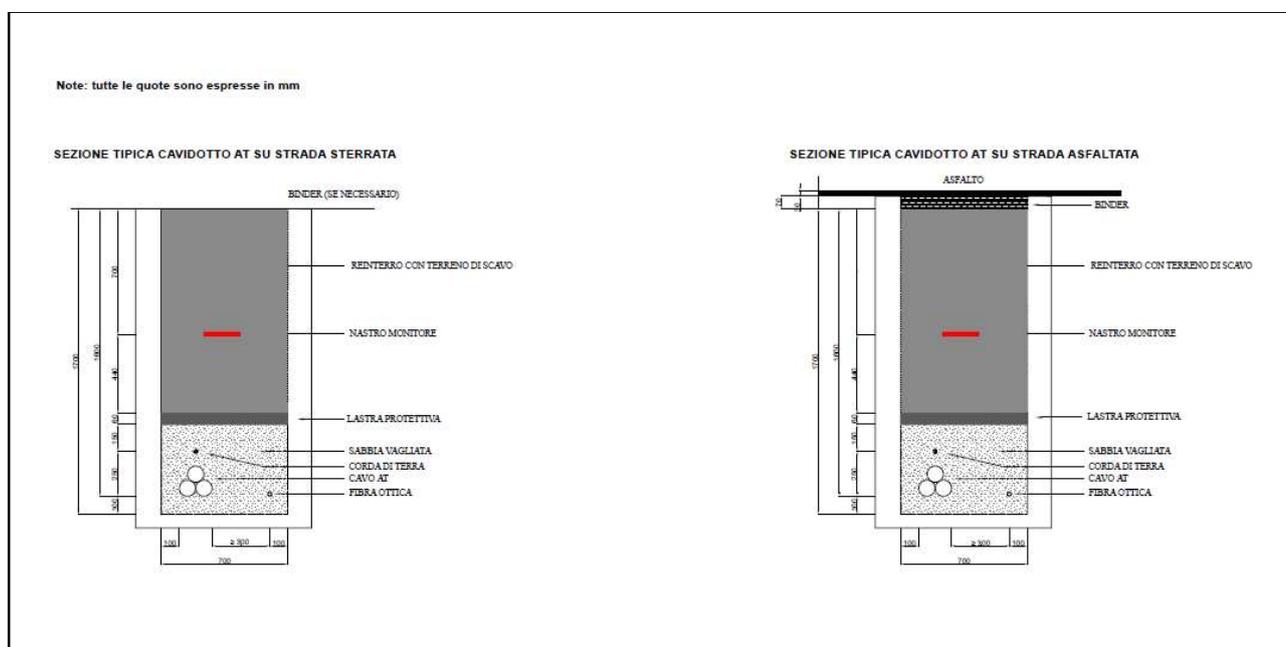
Sezione tipica del cavidotto AT di connessione tra la stazione di trasformazione 150/33 KV e la stazione di condivisione
